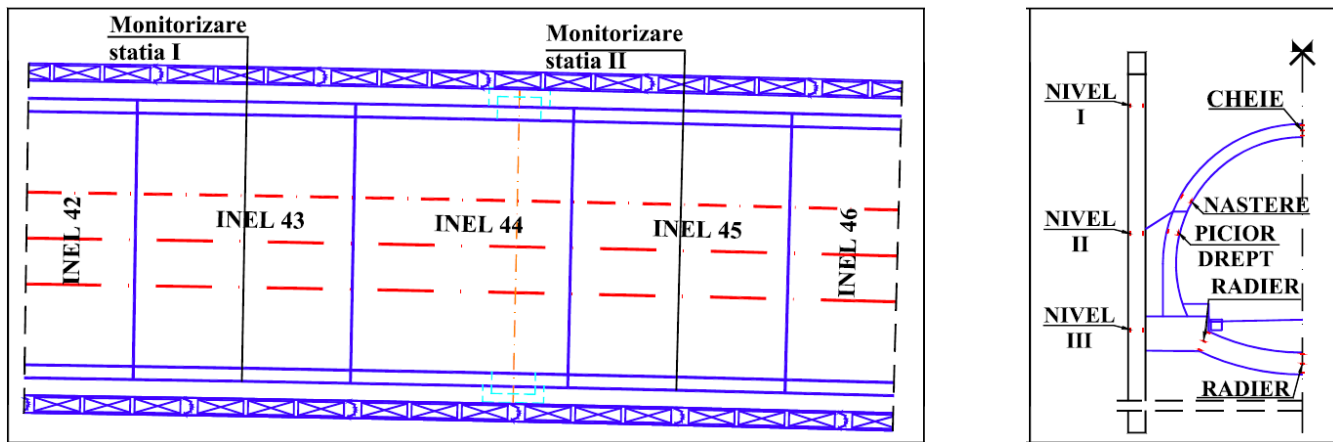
Vedere în plan a stațiilor de monitorizare și schemă de amplasare a mărcilor tensometrice
